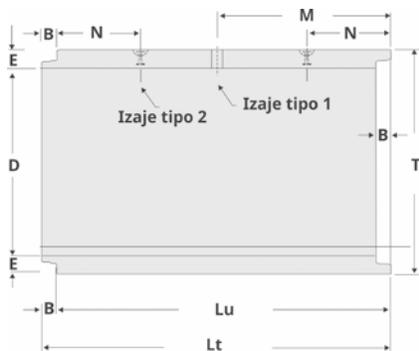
Geometría de las tuberías con diámetros mayores a 1200 m
